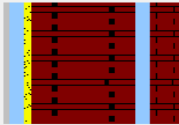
Cerramiento vertical "*Fachada principal*"
